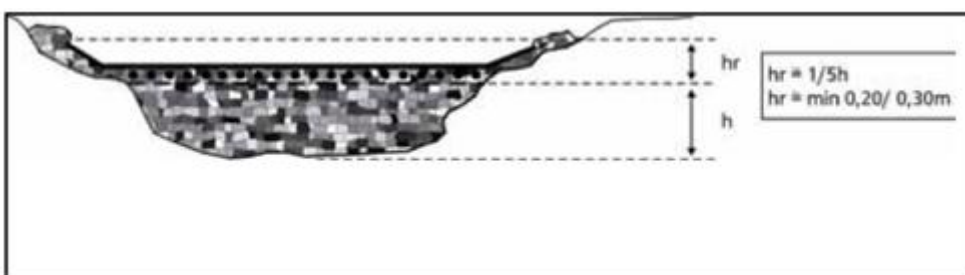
Planta Baixa de uma Barragem Sucessiva de Pedra
